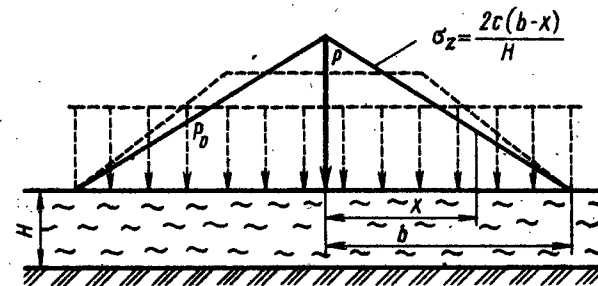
Схема к расчету устойчивости насыпи на тонком слое пластичного грунта
